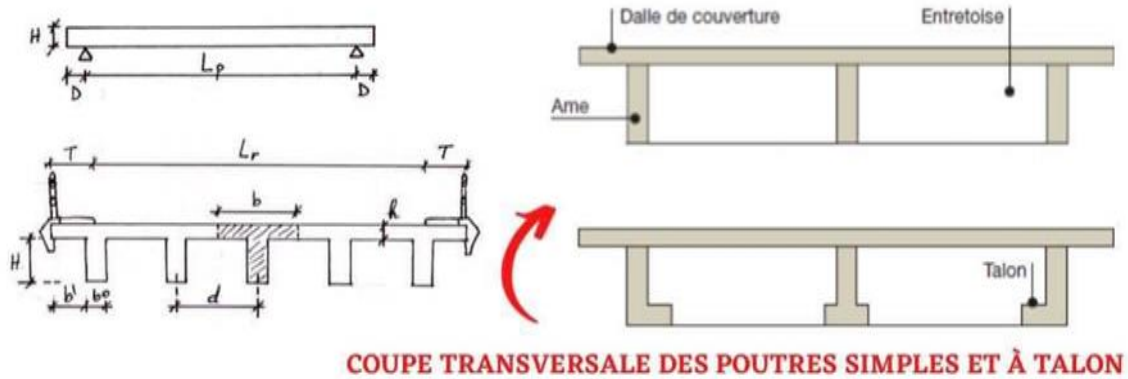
Schéma d'une coupe transversale des poutres simples et a talon.
